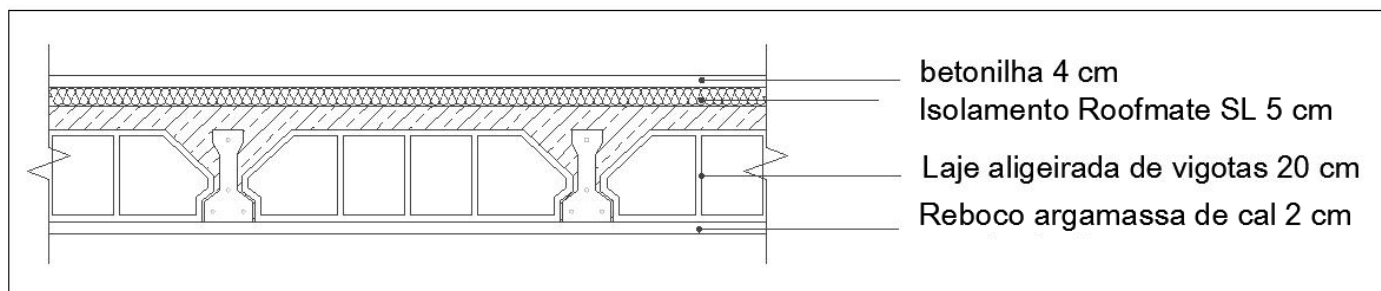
Pormenor construtivo de cobertura em contacto com desvão não ventilado da solução existente
